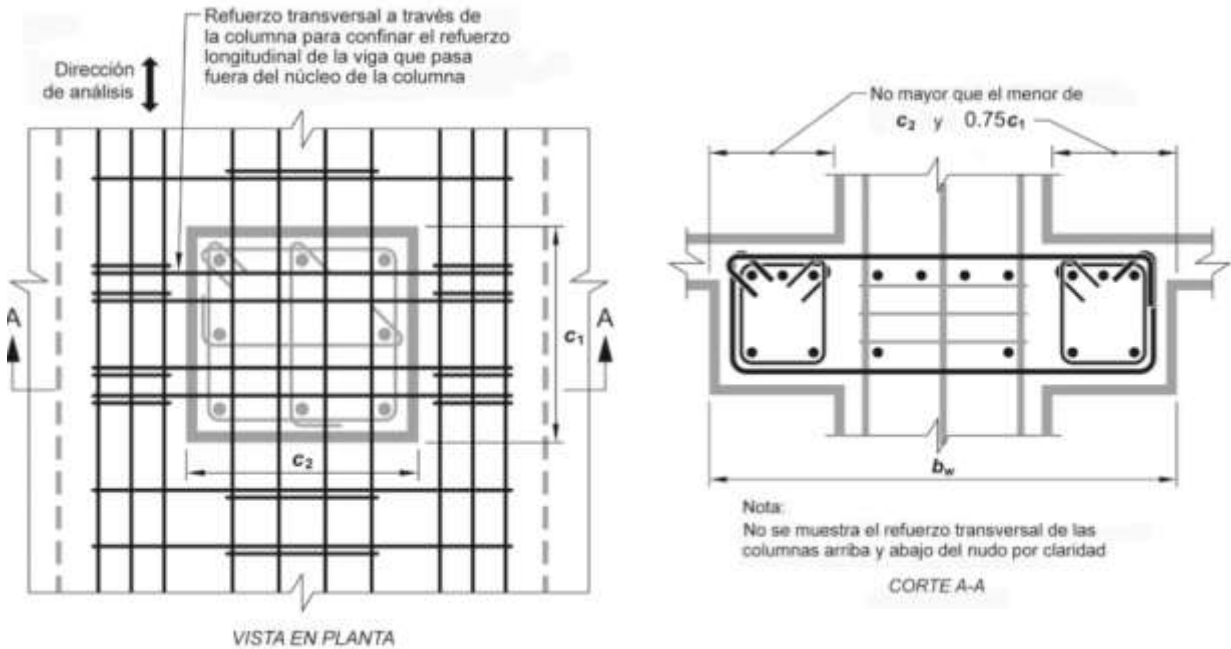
ANCHO MAXIMO EFECTIVO DE VIGA ANCHA
